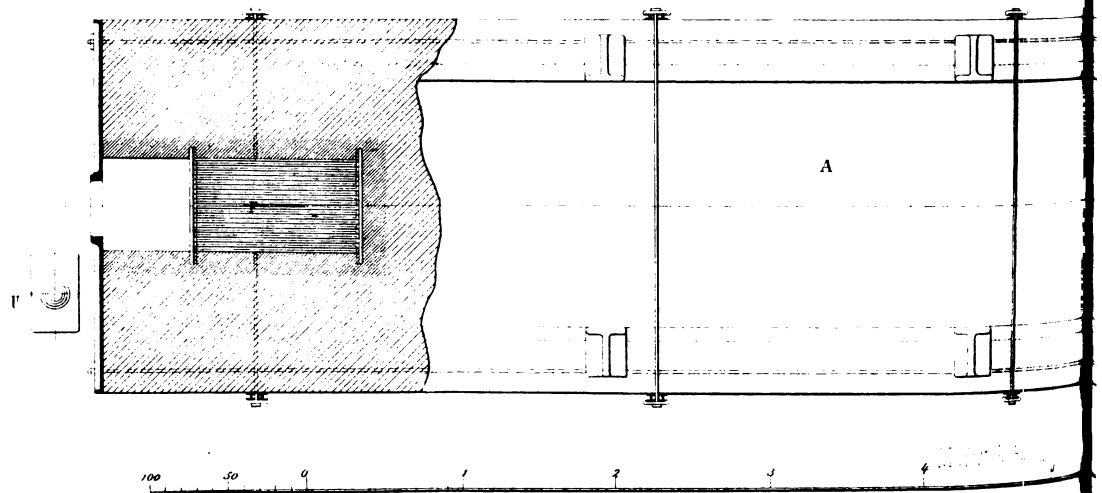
Grundriss u. Schnitt nach C D (Fig. 1)
